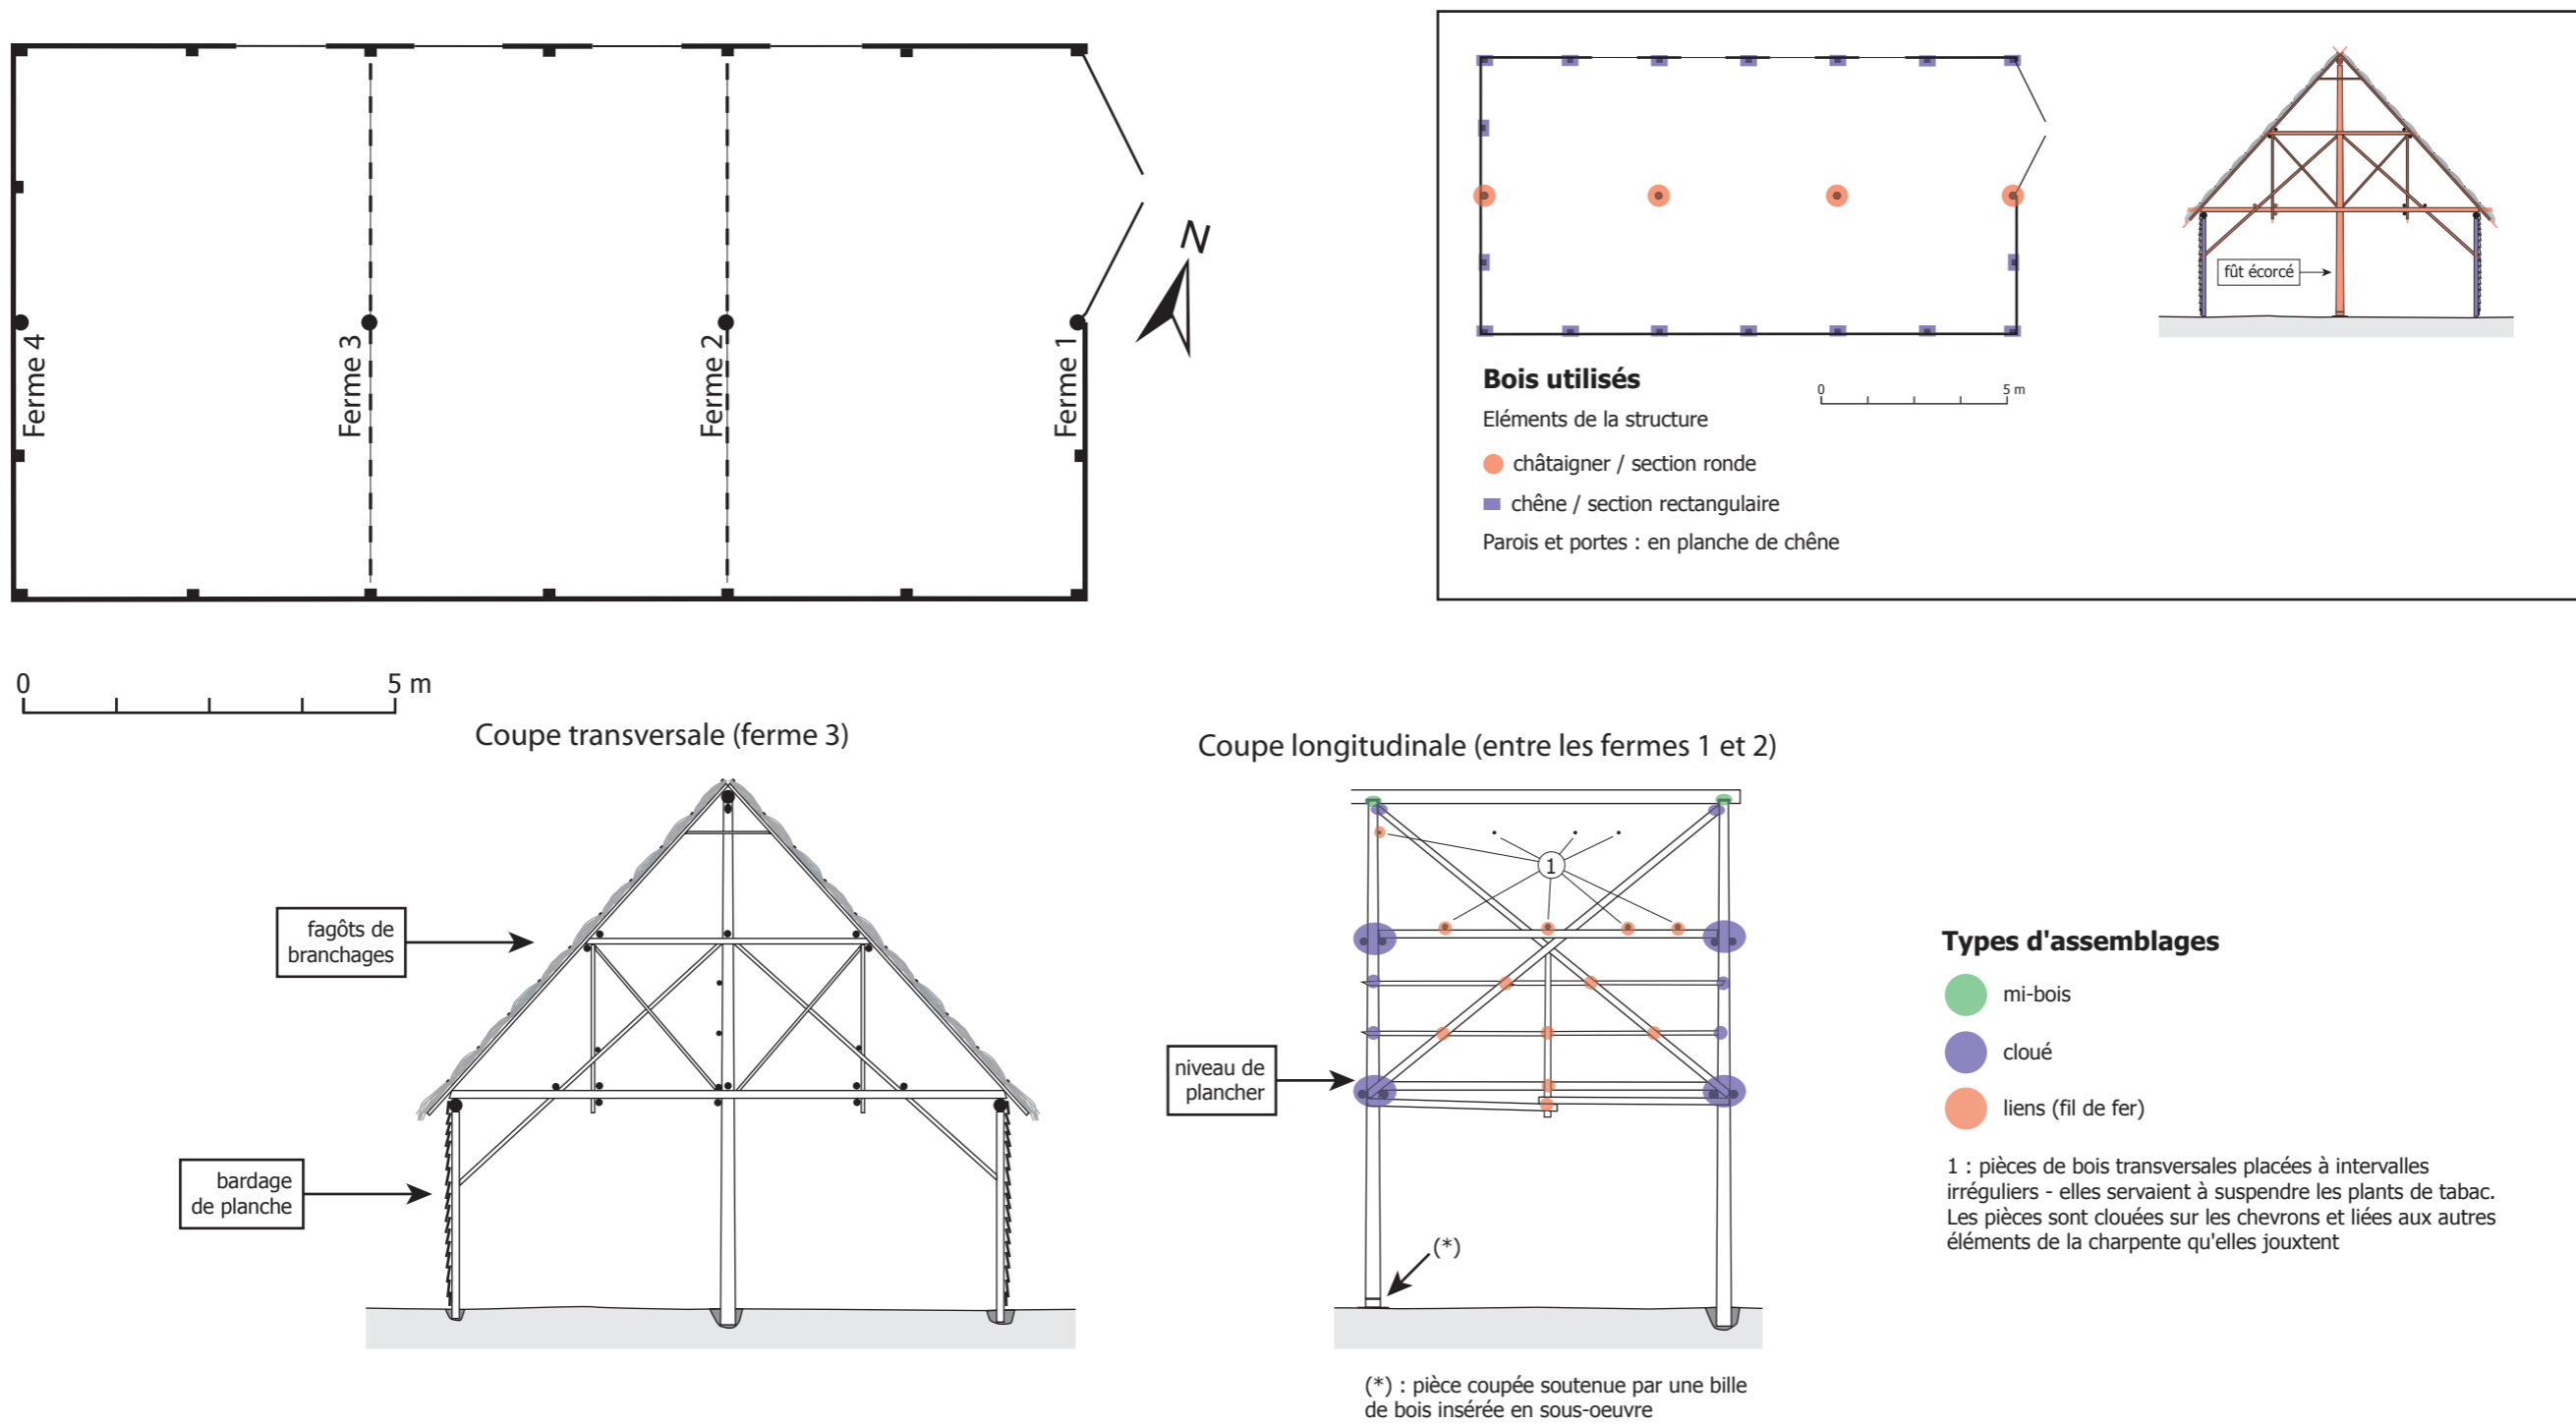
plan de la structure, coupe transversale du bâtiment au niveau d'une ferme, coupe longitudinale du bâtiment entre deux fermes (M. Gaultier - SADIL)
